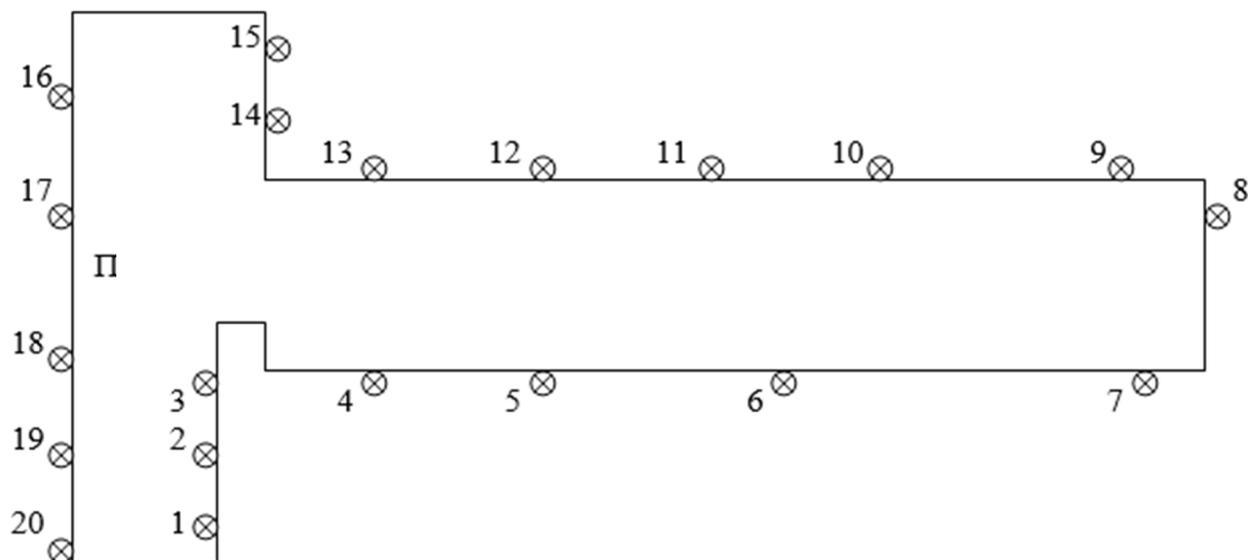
План размещения геодезических марок в стене жилого здания по ул. Октябрьская, 40
